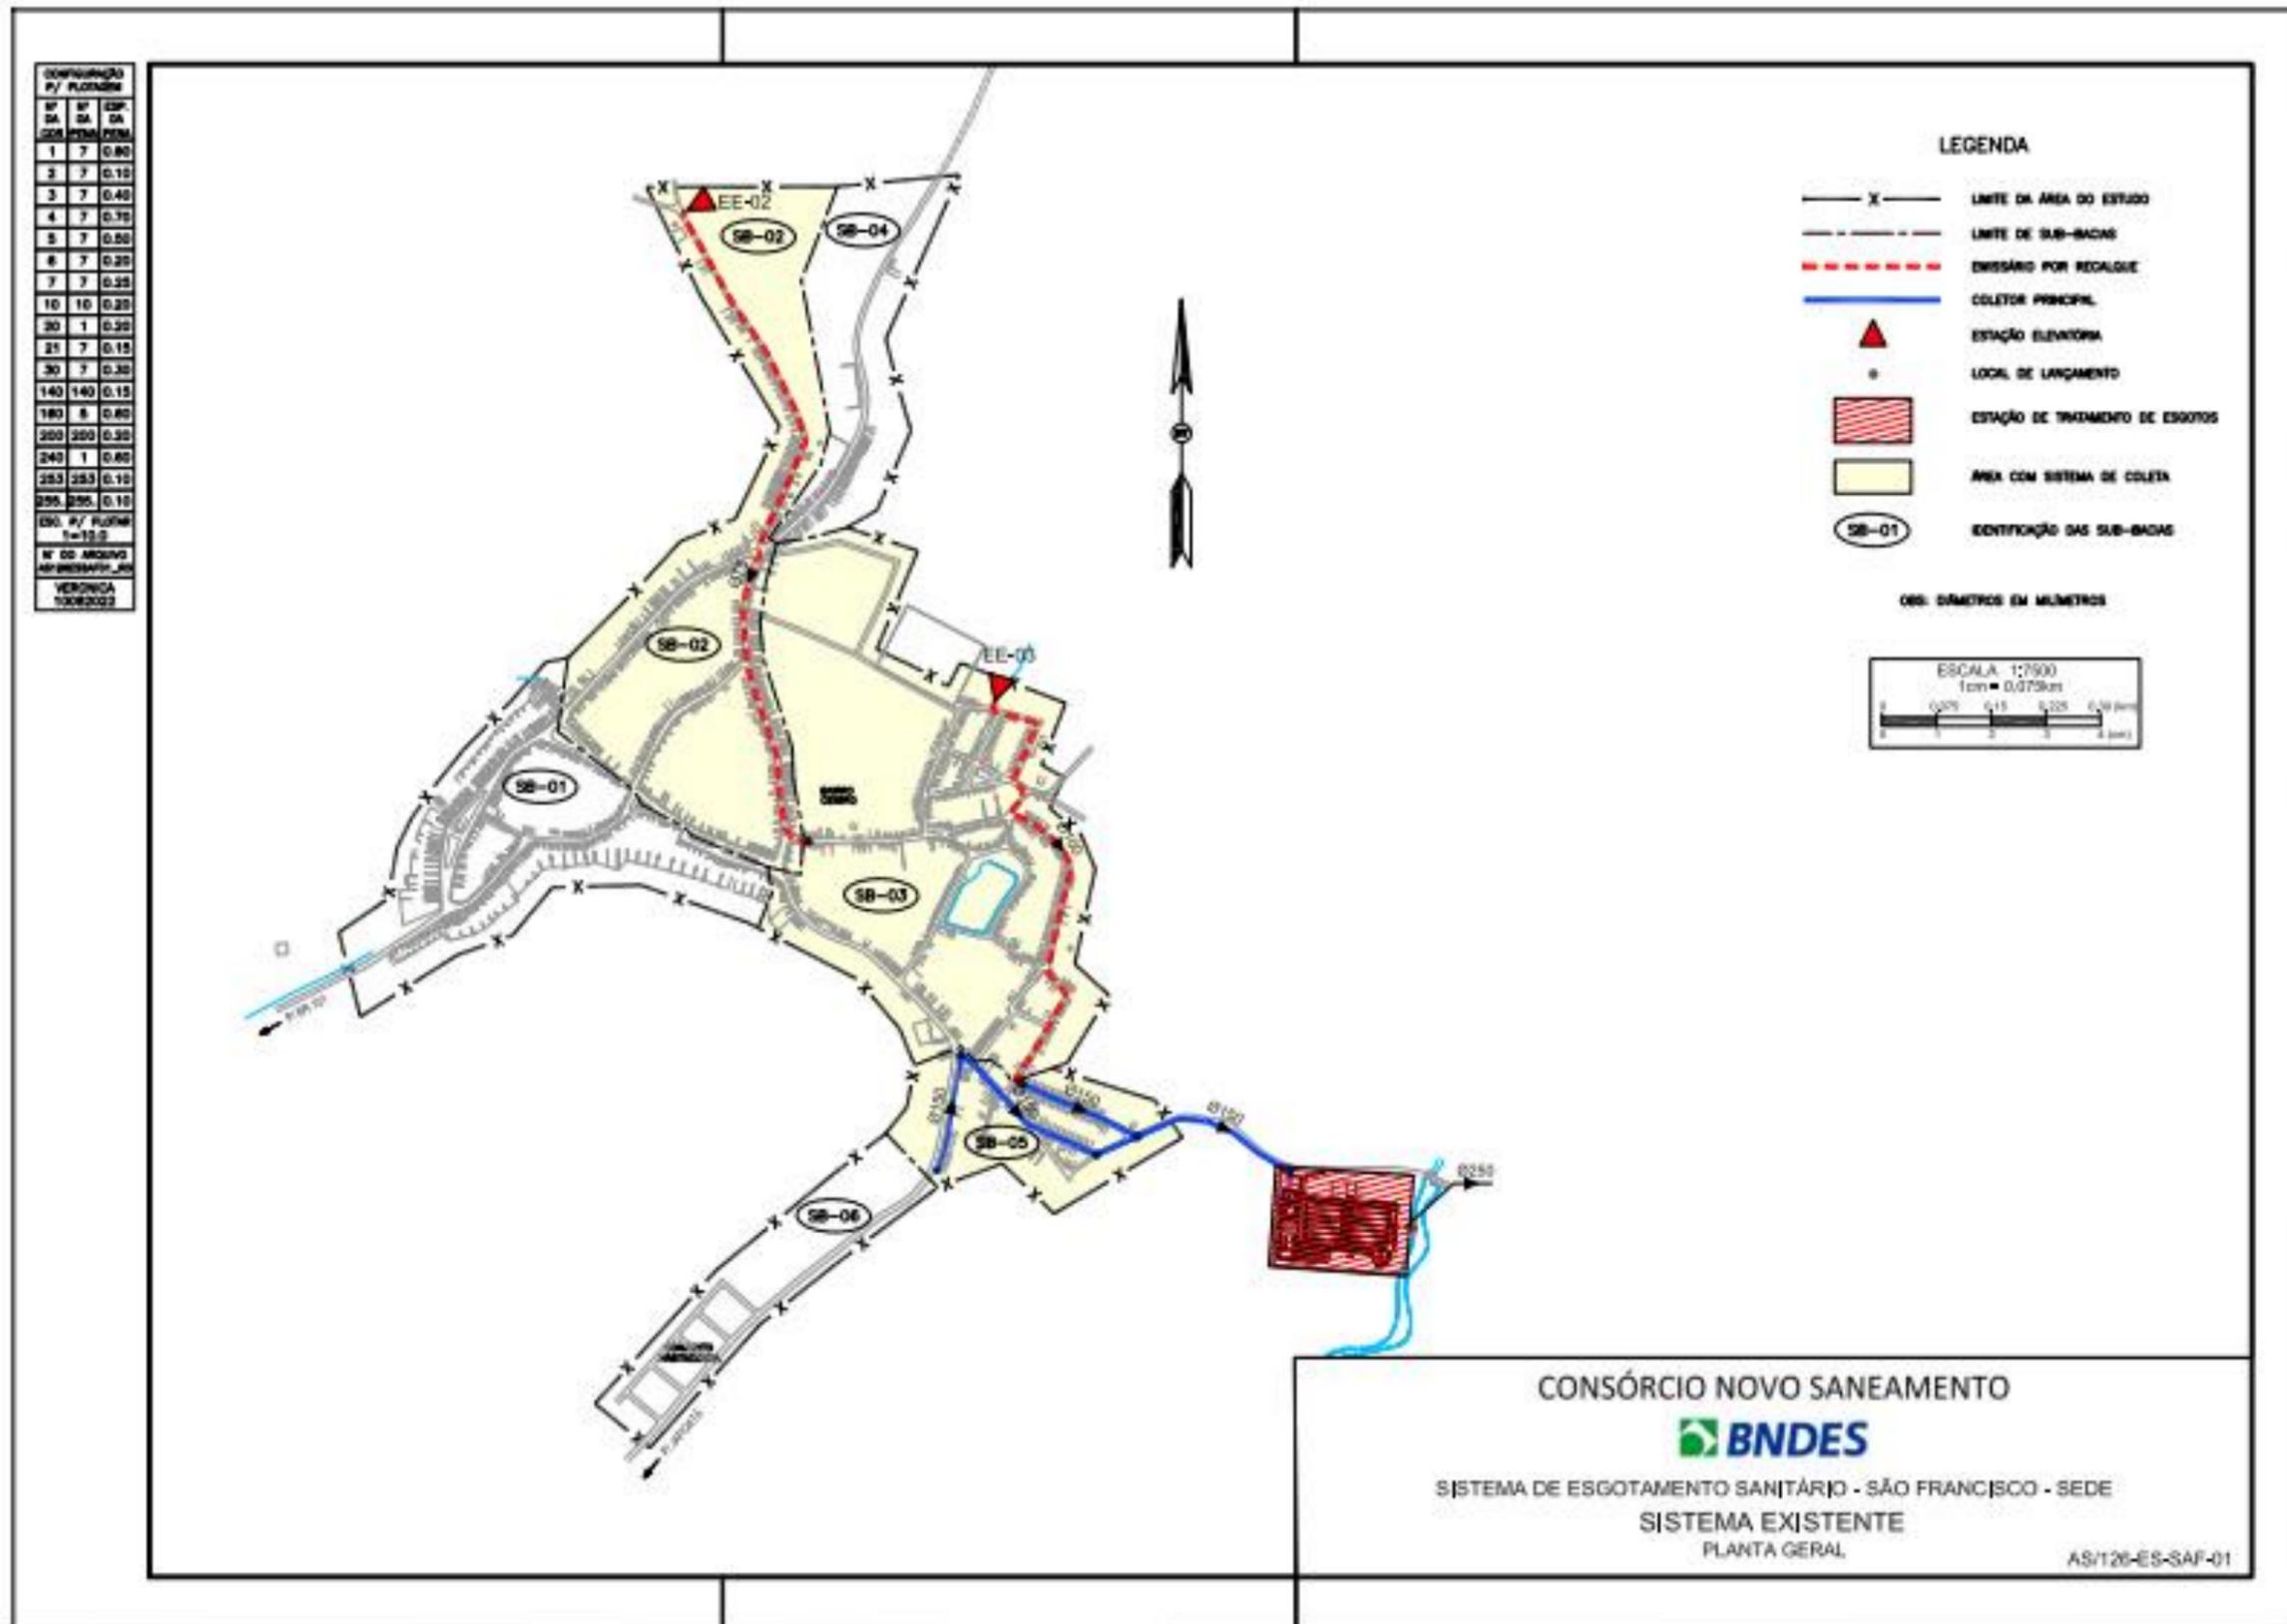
Planta do Sistema de Esgotamento Sanitário – SÃO FRANCISCO
